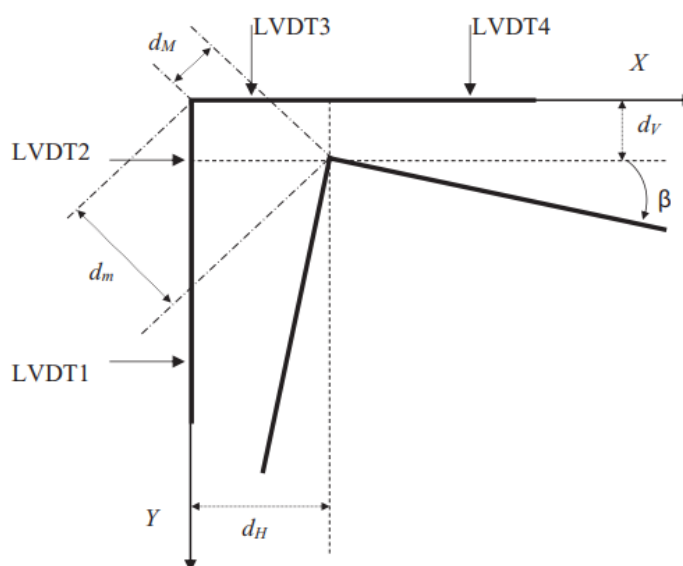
Esquema das configurações indeformada e deformada das cantoneiras [26].
